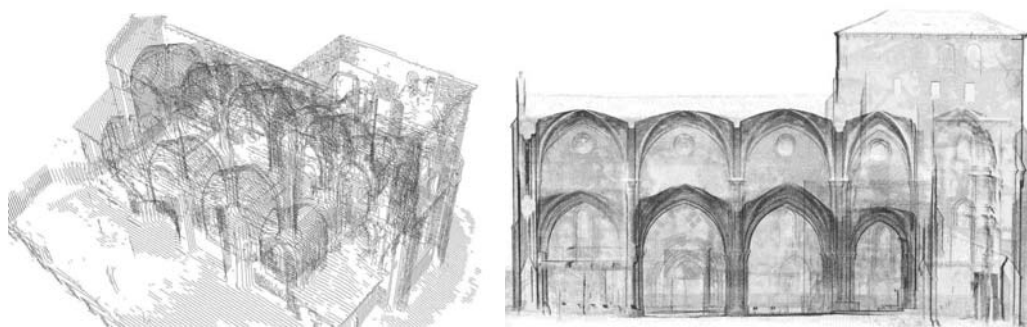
Mapas de secciones planas paralelas Fig.20: Proyección de secciones sobre plano común
